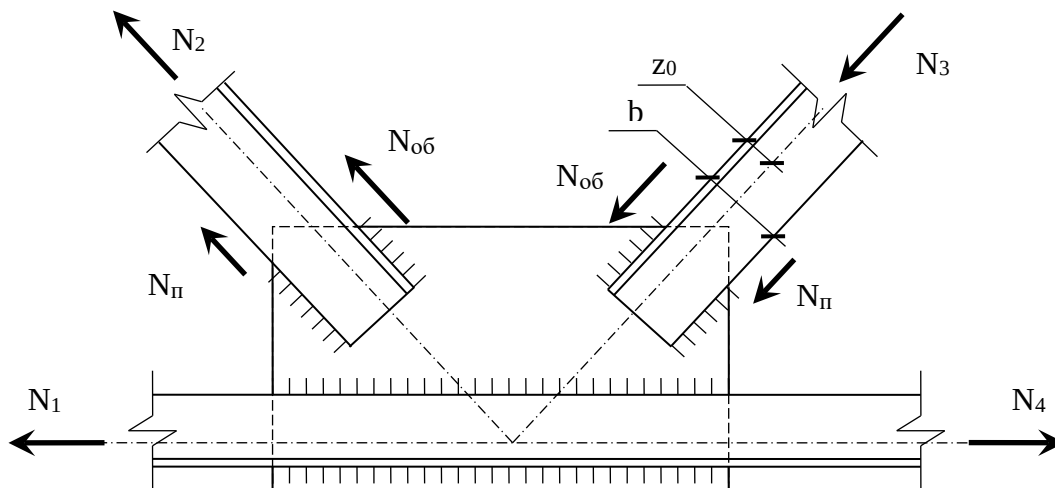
Промежуточный узел нижнего пояса фермы из парных уголков
